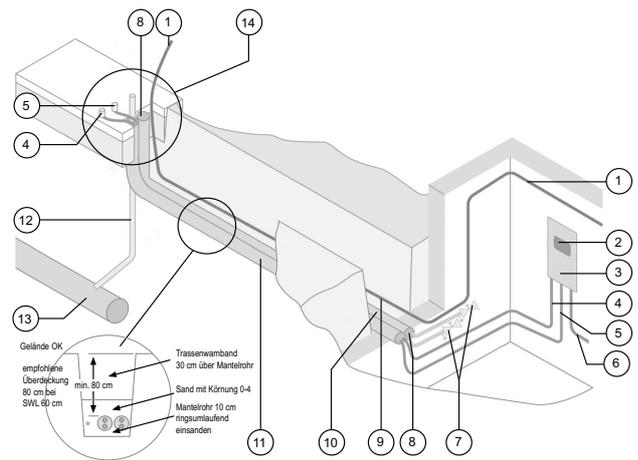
Skizze Mauerdurchführung drückendes Wasser
